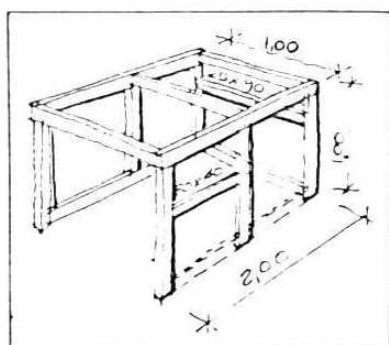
Detalhe de construção de gaiola ou abrigo individual.
